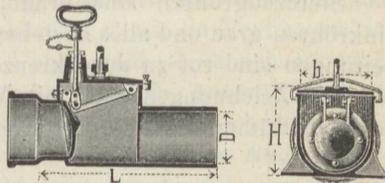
Rückstauverschluß mit Feststellvorrichtung.
